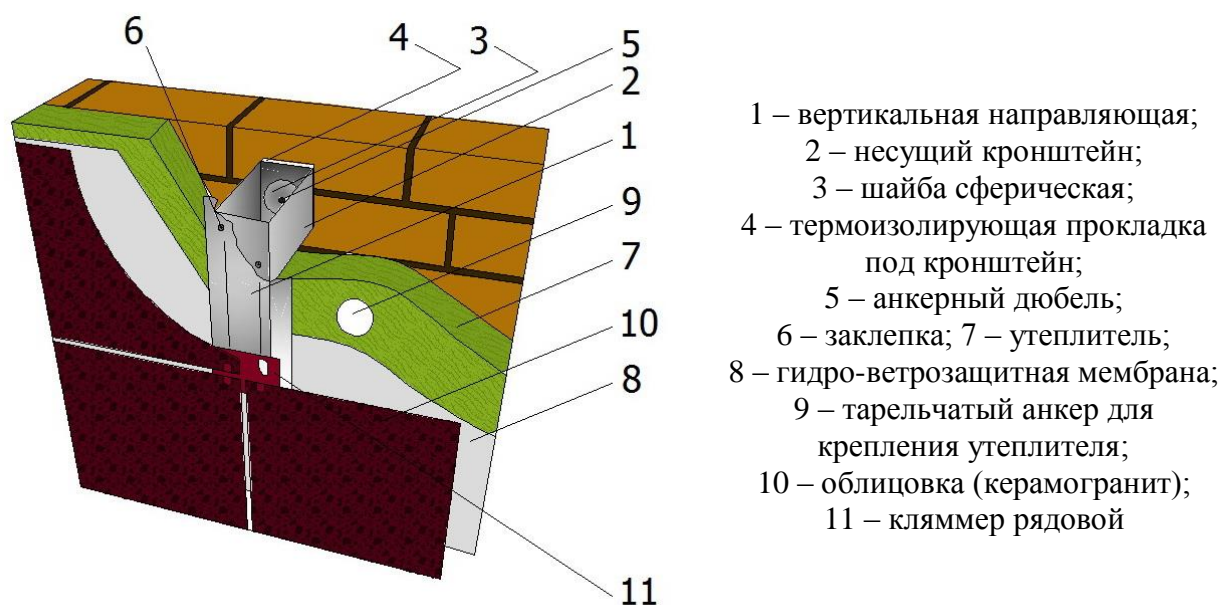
Конструктивное решение вентилируемого фасада «РУСЭКСП»
